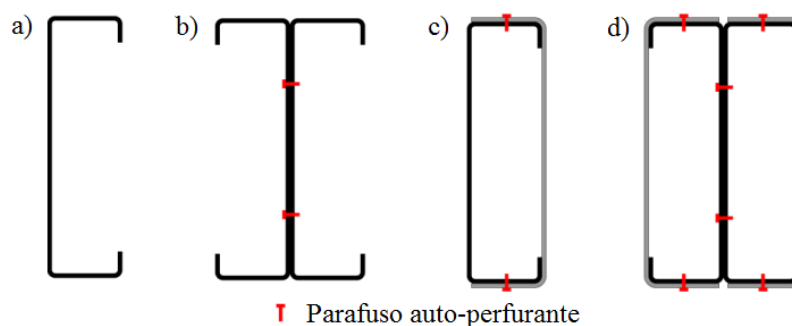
Secções transversais sujeitas a ensaio: a) Secção C; b) Secção I; c) Secção R; d) Secção 2R (adaptado de Craveiro, 2015).
